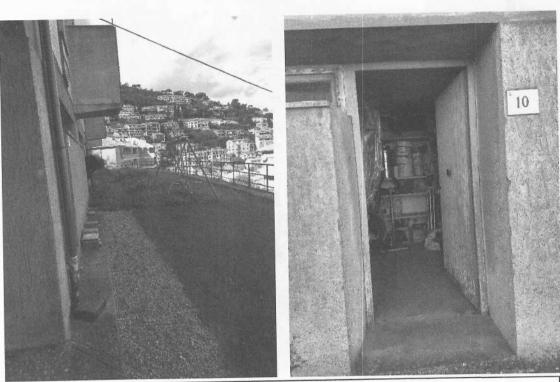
e 35: Vista esterna della corte comune al piano seminterrato dalla quale si accede al locale cantina e dell'ingresso alla cantina stessa.
